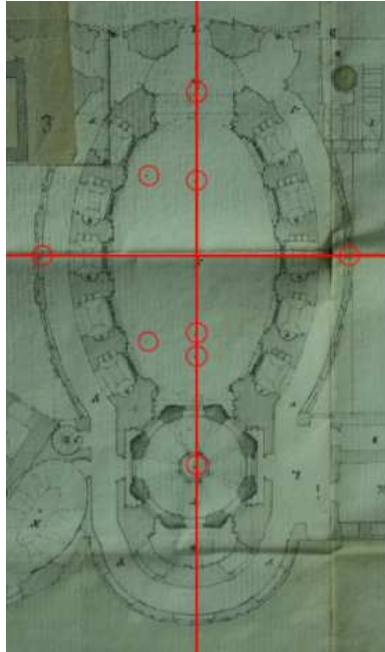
Elipsograf, použitie; zdroj: <https://drawingmachines.org/>
